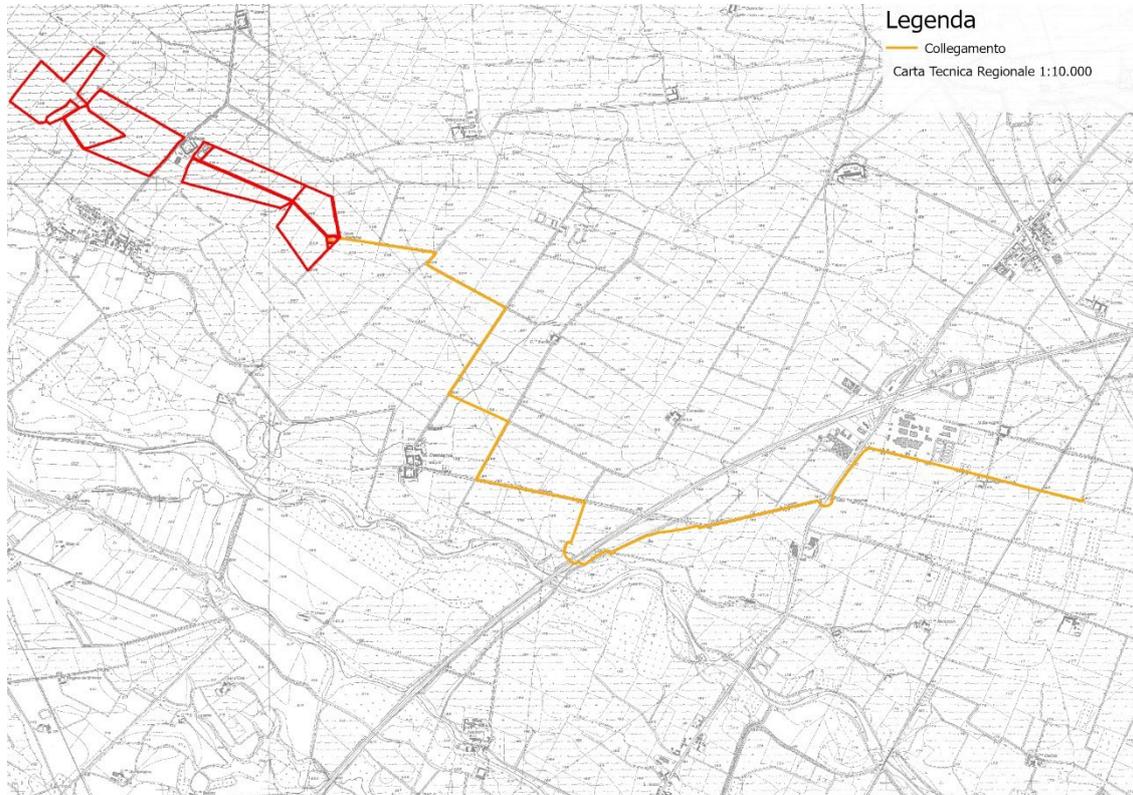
Planimetria su CTR dell'opera fino al collegamento alla Stazione Elettrica 380/132 kV Carisio
